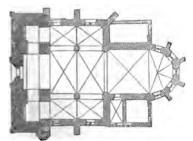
Moordorf. Kirche. Grundriss. 1:667.
